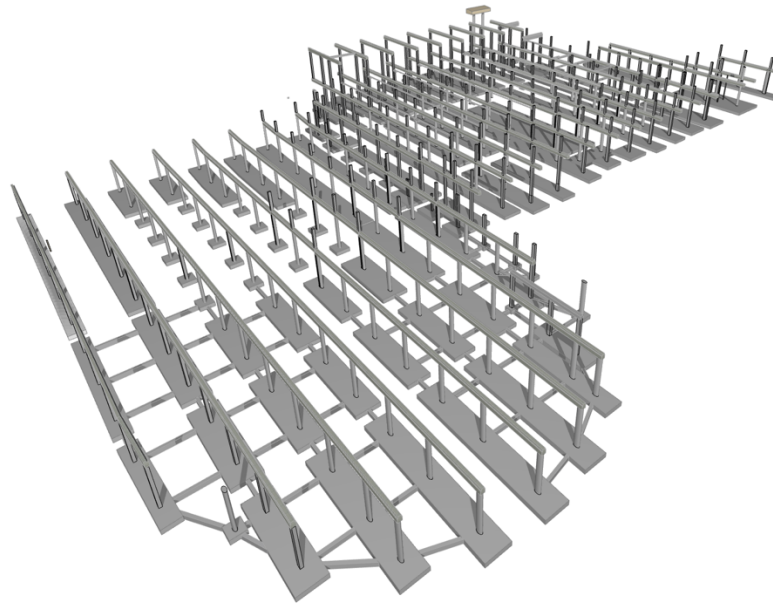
Volumetría final de la estructura. Fuente: Elaboración propia.
